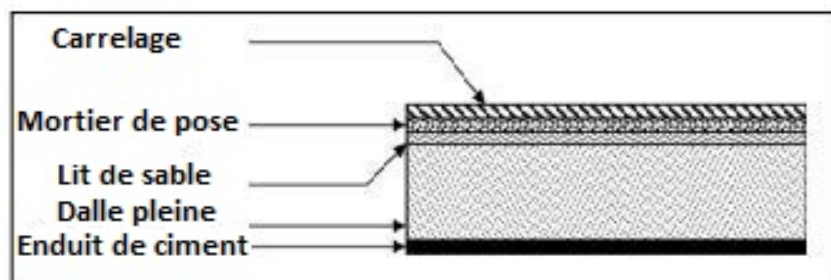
Détails d'un balcon en dalle pleine en B.A (étage courant)
